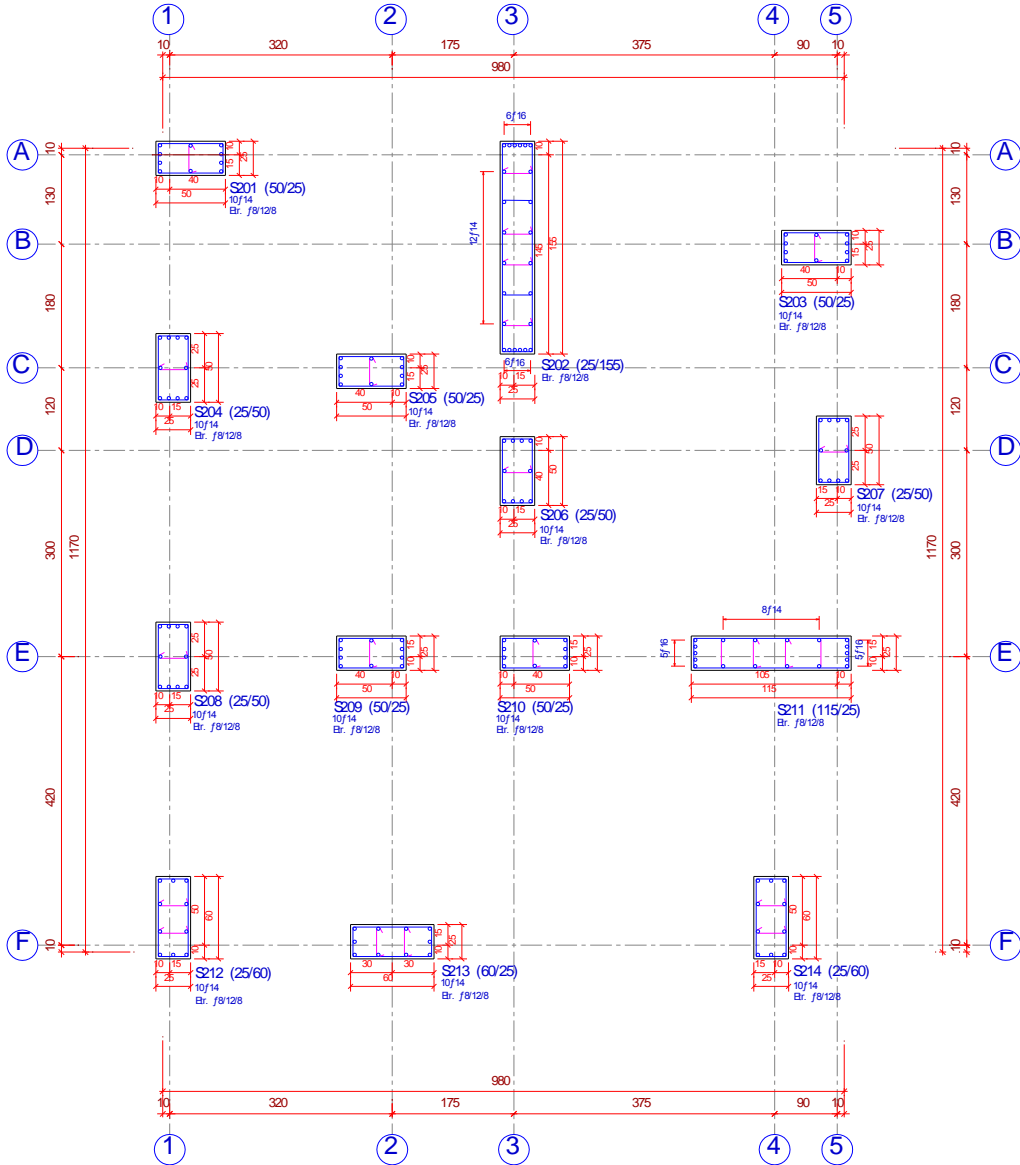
Kolon aplikasyon planı dış ölçülendirmesi
